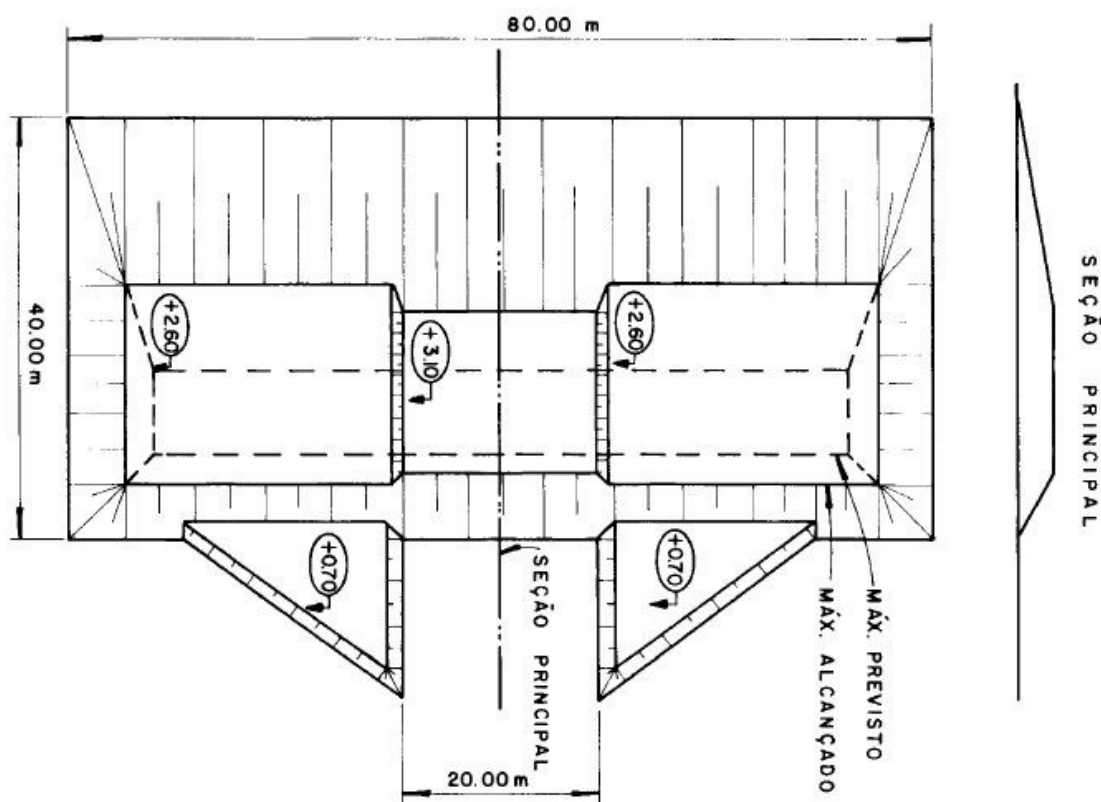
Seção transversal principal e vista em planta da geometria do Aterro Experimental levado à ruptura (Ortigão, 1980)
